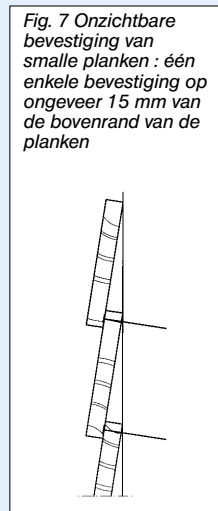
Onzichtbare bevestiging van smalle planken : één enkele bevestiging op ongeveer 15 mm van de bovenrand van de planken
